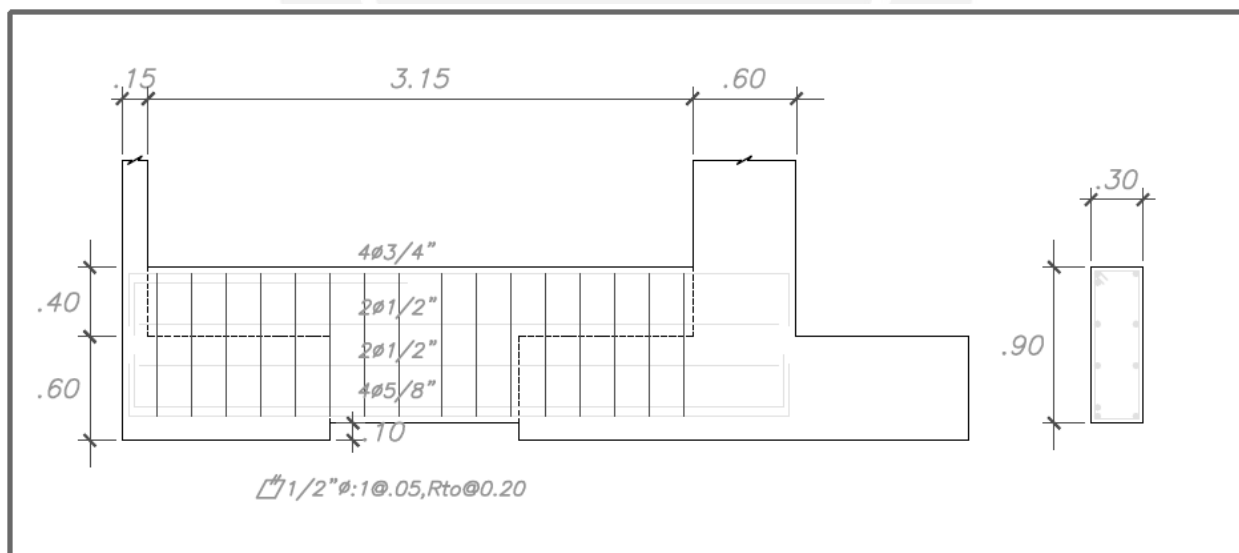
Diseño de viga de cimentación 1A-1B. Longitudes en metros.
